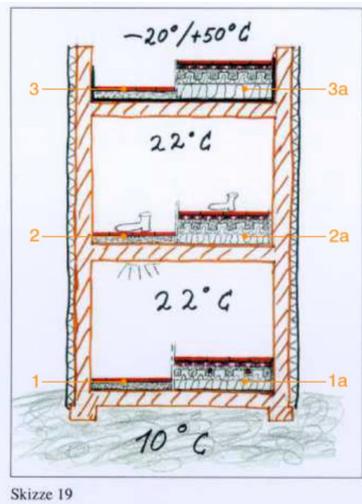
Ejemplos de aplicación de pavimentos flotantes en la edificación.
